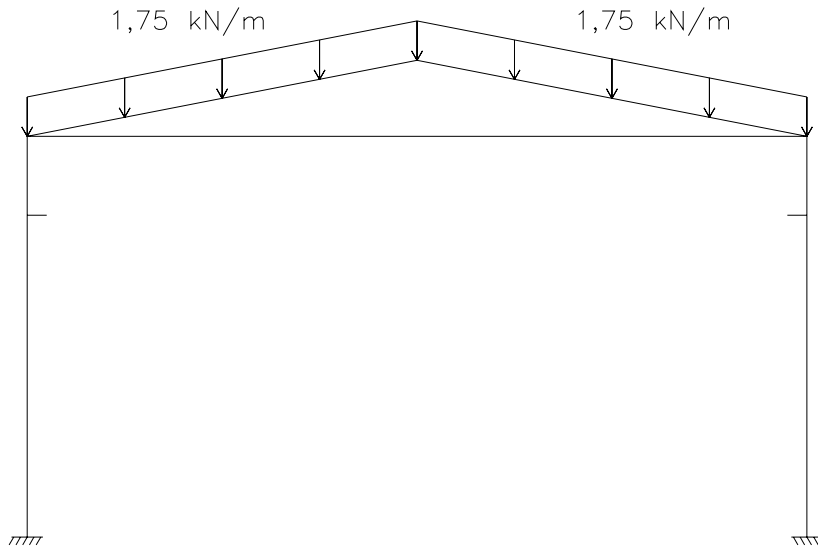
Pórtico utilizado para o sistema de ligação viga-pilar com chumbadores e consola horizontal (exemplo 7.1).
